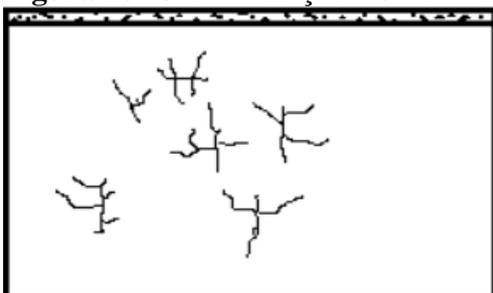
Fissuras mapeadas encontradas na fachada de uma residência.
